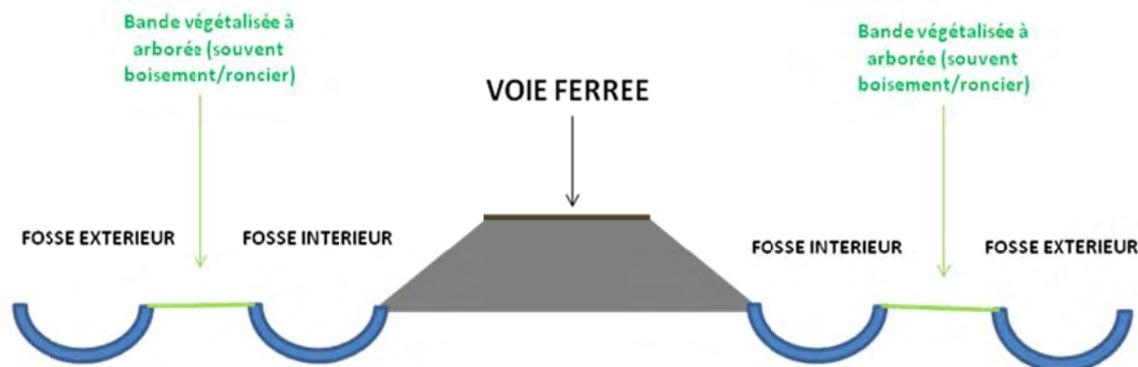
Schéma de principe de drainage de la ligne ferroviaire du Bec d'Ambès. Coupe transversale (Source Simethis).
